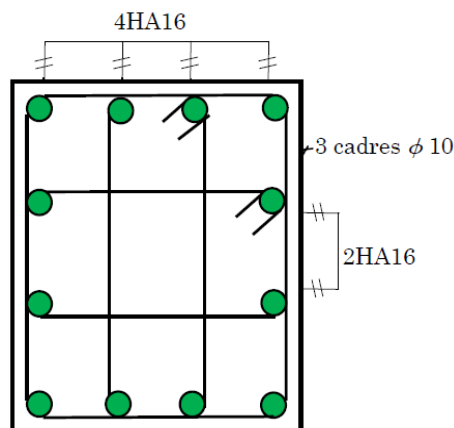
Schéma de ferrailage des poteaux 7^{ème}, 8^{ème}, 9^{ème} étage et terrasse
